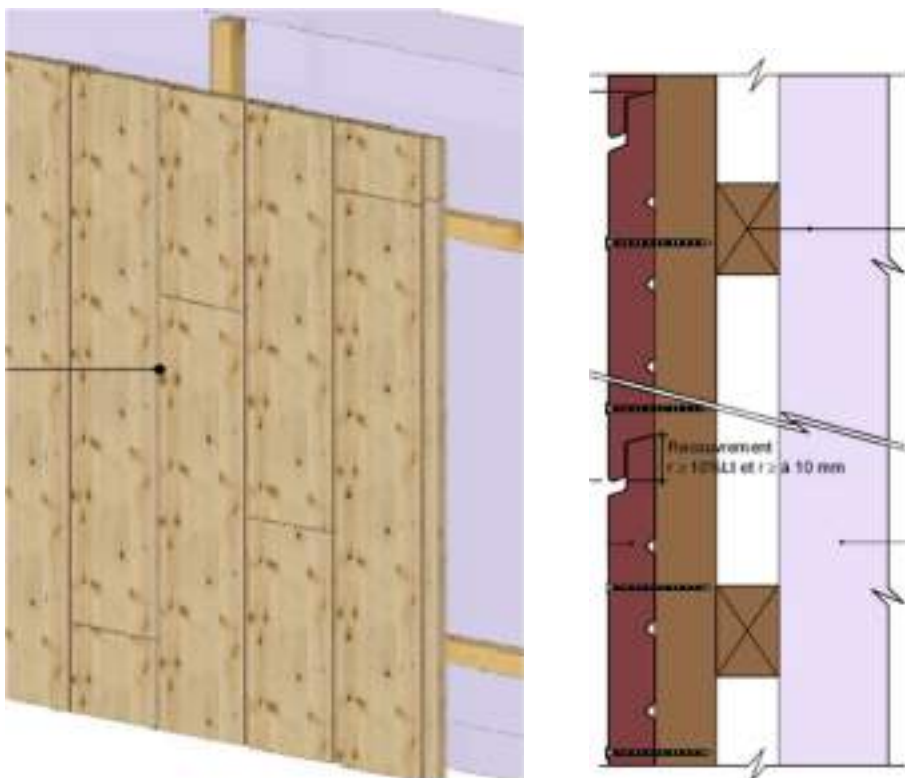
Lames à mi-bois – pose verticale (illustration 3D et coupe horizontale)
